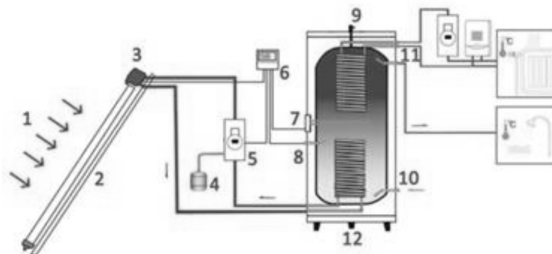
Схема внешних соединений СВНУ высокого давления с вакуумными коллекторами:
